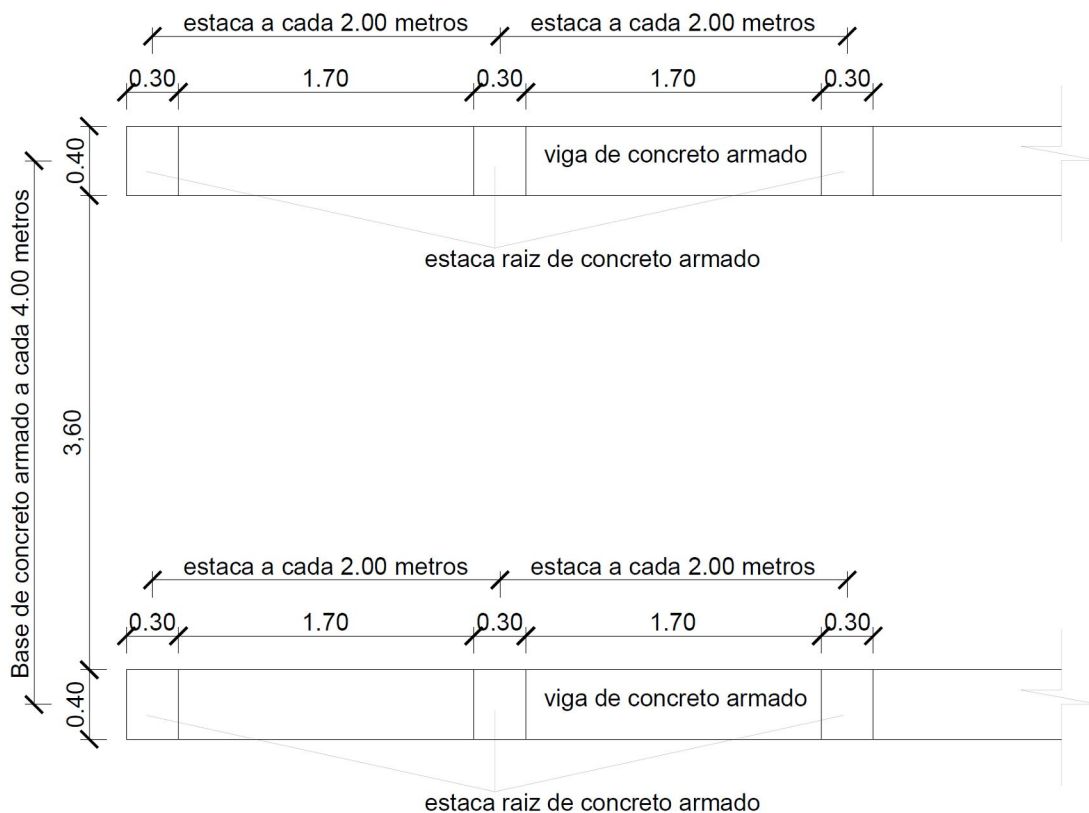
Detalhamento do bloco de assentamento das escolas em planta baixa
